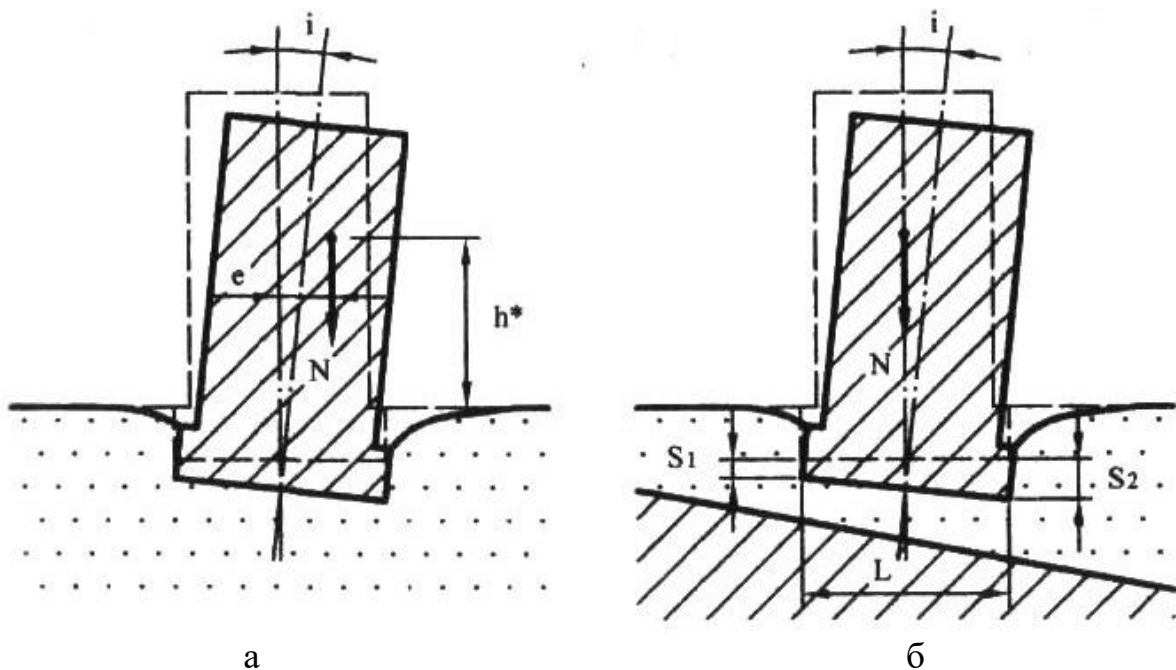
Схеми нахилу фундаментів: а – при відцентровому навантаженні; б – при неоднорідності ґрунтів основи в плані та по глибині
